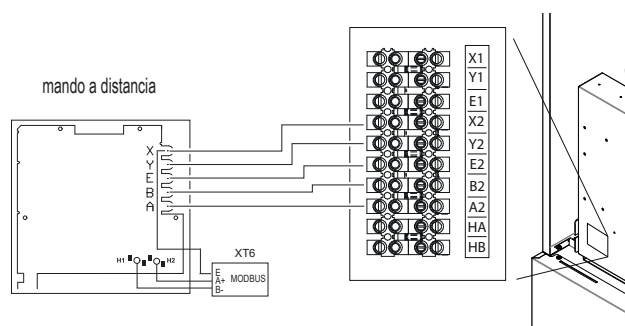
Cablaggio del comando remoto con unità esterna R32
